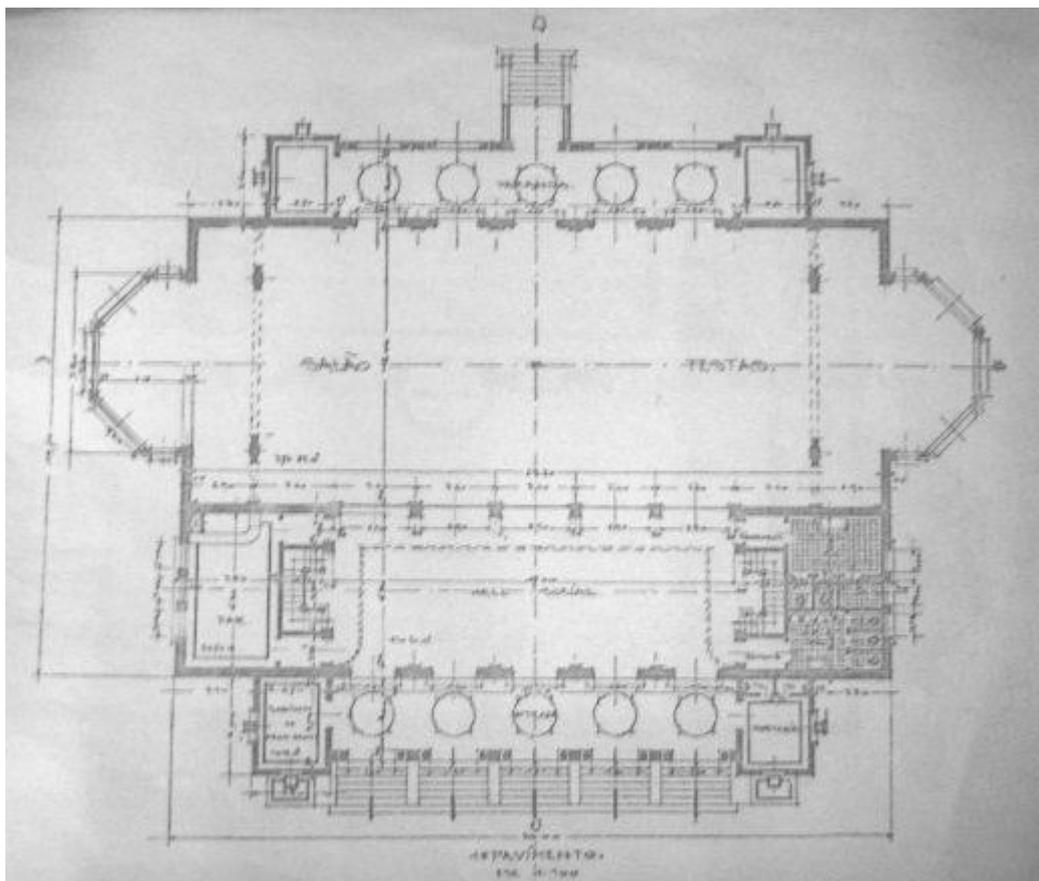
Projeto para a Sede Botafogo Futebol de Regatas - Planta Baixa Segundo Pavimento.
